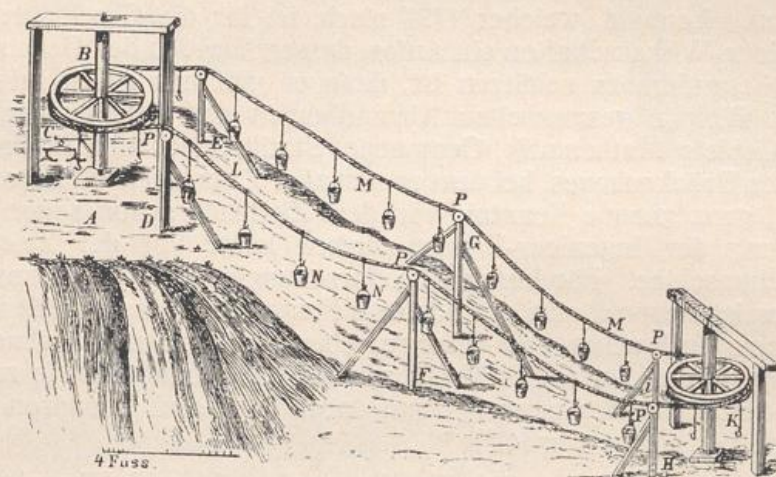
Leupold, 1724, die Dantziger Maschine.
